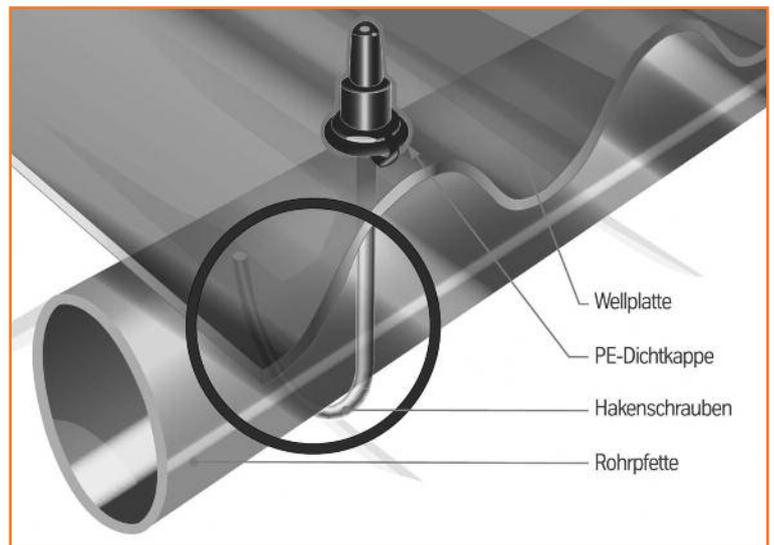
Befestigung von Wellplatten PLEXIGLAS® Resist/Heatstop mit Hakenschraube und PE-Dichtkappe
